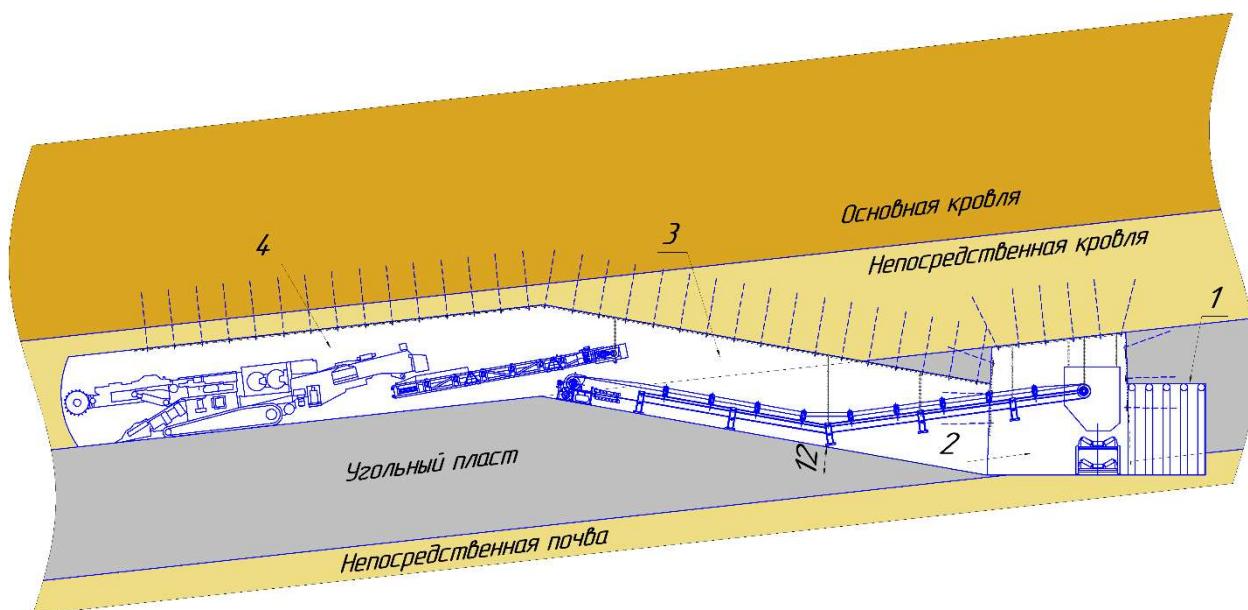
Схема проведения закладываемой выработки в кровле будущей монтажной камеры. (1 – ниша, 2 – подготовительная выработка, 3 – заезд, 4 – закладываемая выработка, 12 – угол наклона заезда)
